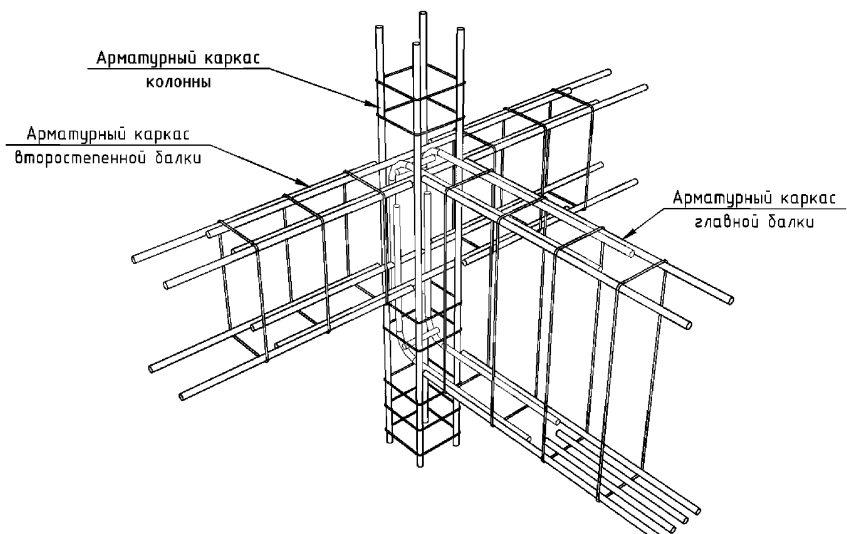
Детальное армирование торцевого узла сопряжения балок с колонной
